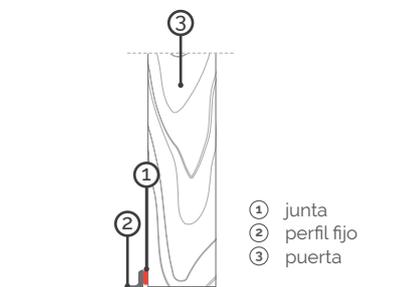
Junta elástica horizontal sujeta a un perfil fijo al pavimento
